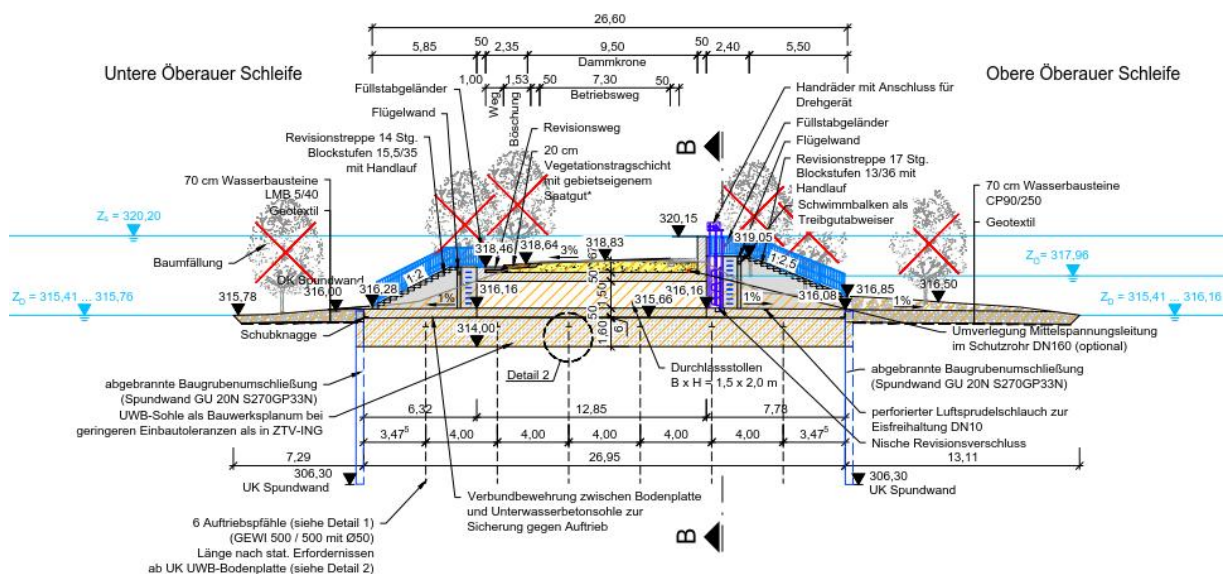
Verbindungsbauwerk, Schnitt A-A (aus Plan 04-03-05)
